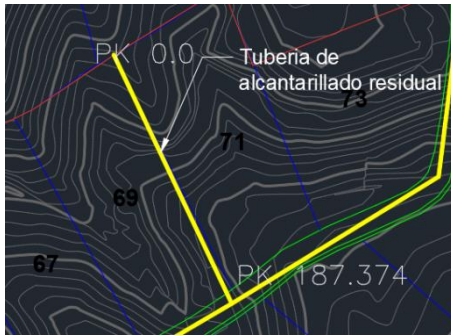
Trazado correcto de alcantarillado residual entre linderos de lote.
